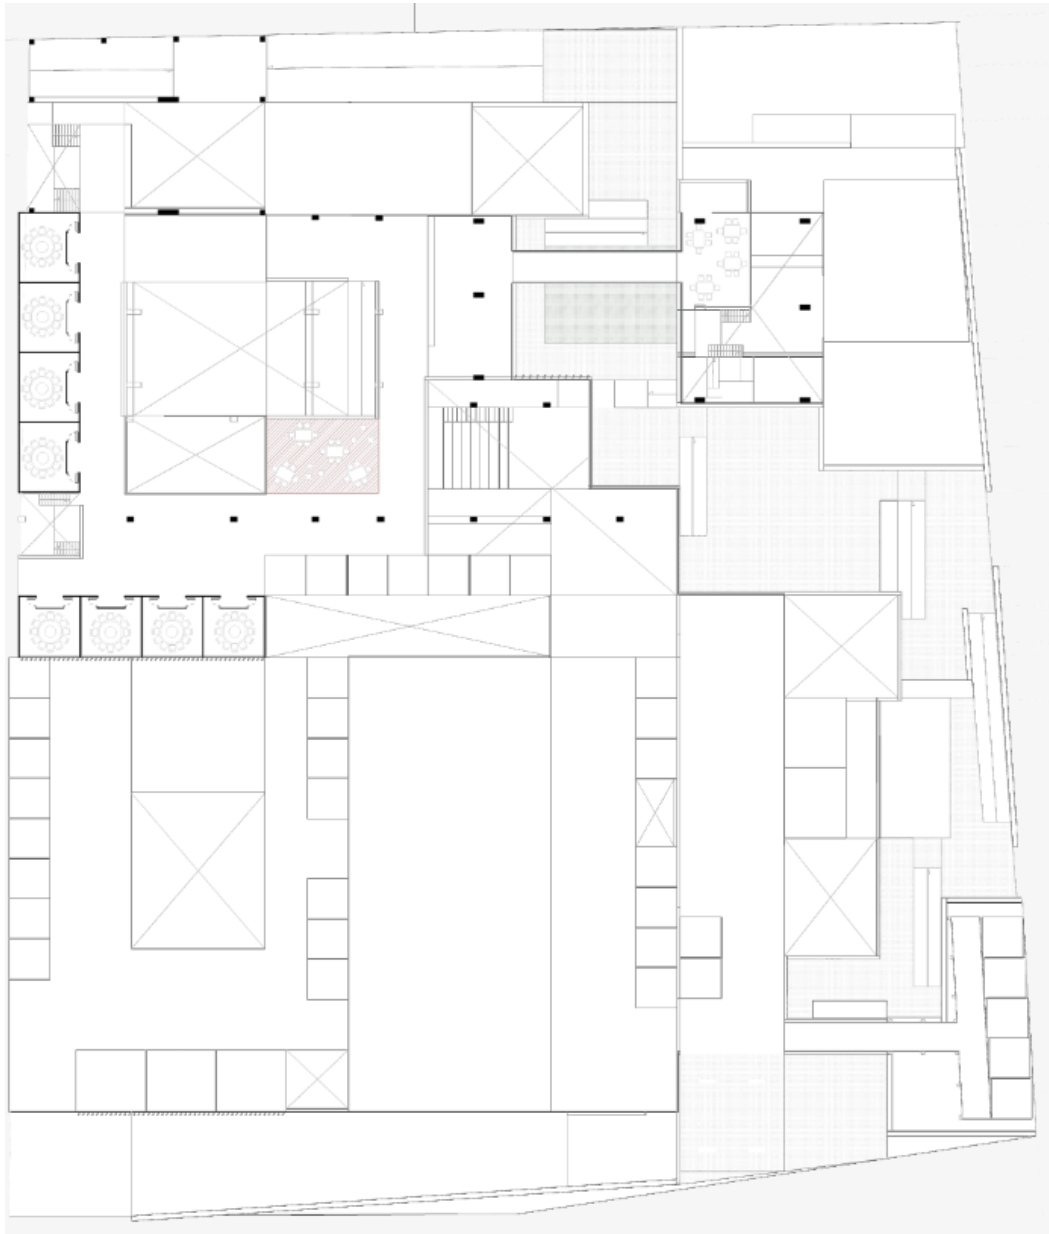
Planta arquitectónica. Tercer nivel, acceso carrera sexta.
